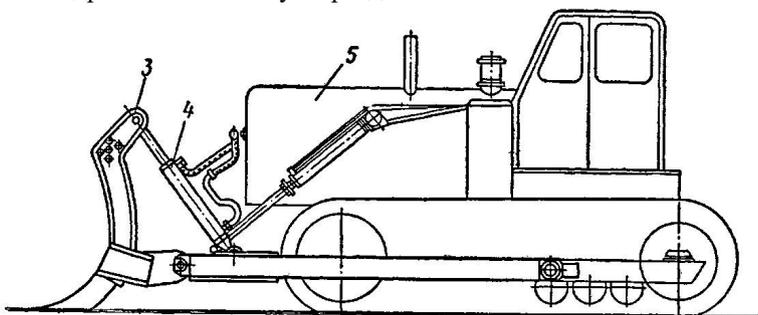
Общий вид корчевателя-сборителя Д-695А:
